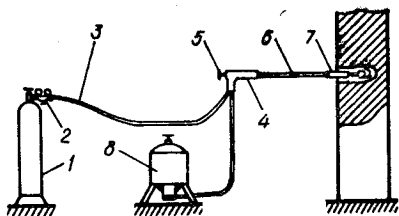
Схема термитно-кислородной установки для резки бетона и железобетона:
